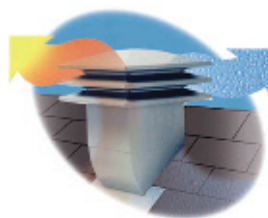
Элементы принудительной вентиляции крыши для пологих крыш
